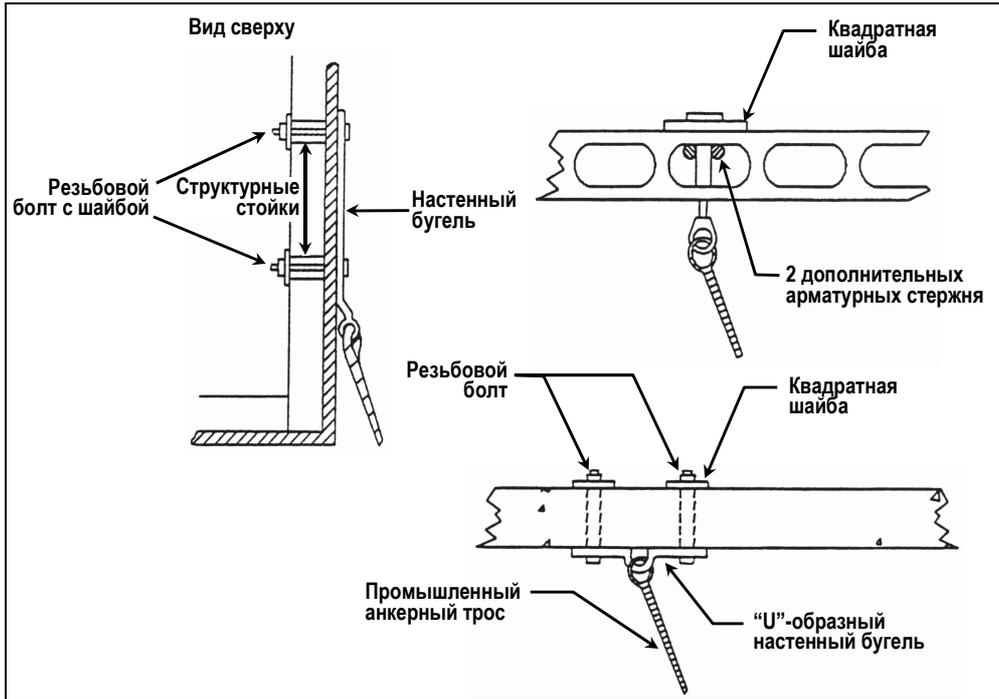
Примеры креплений к стенам зданий без внешней облицовки
